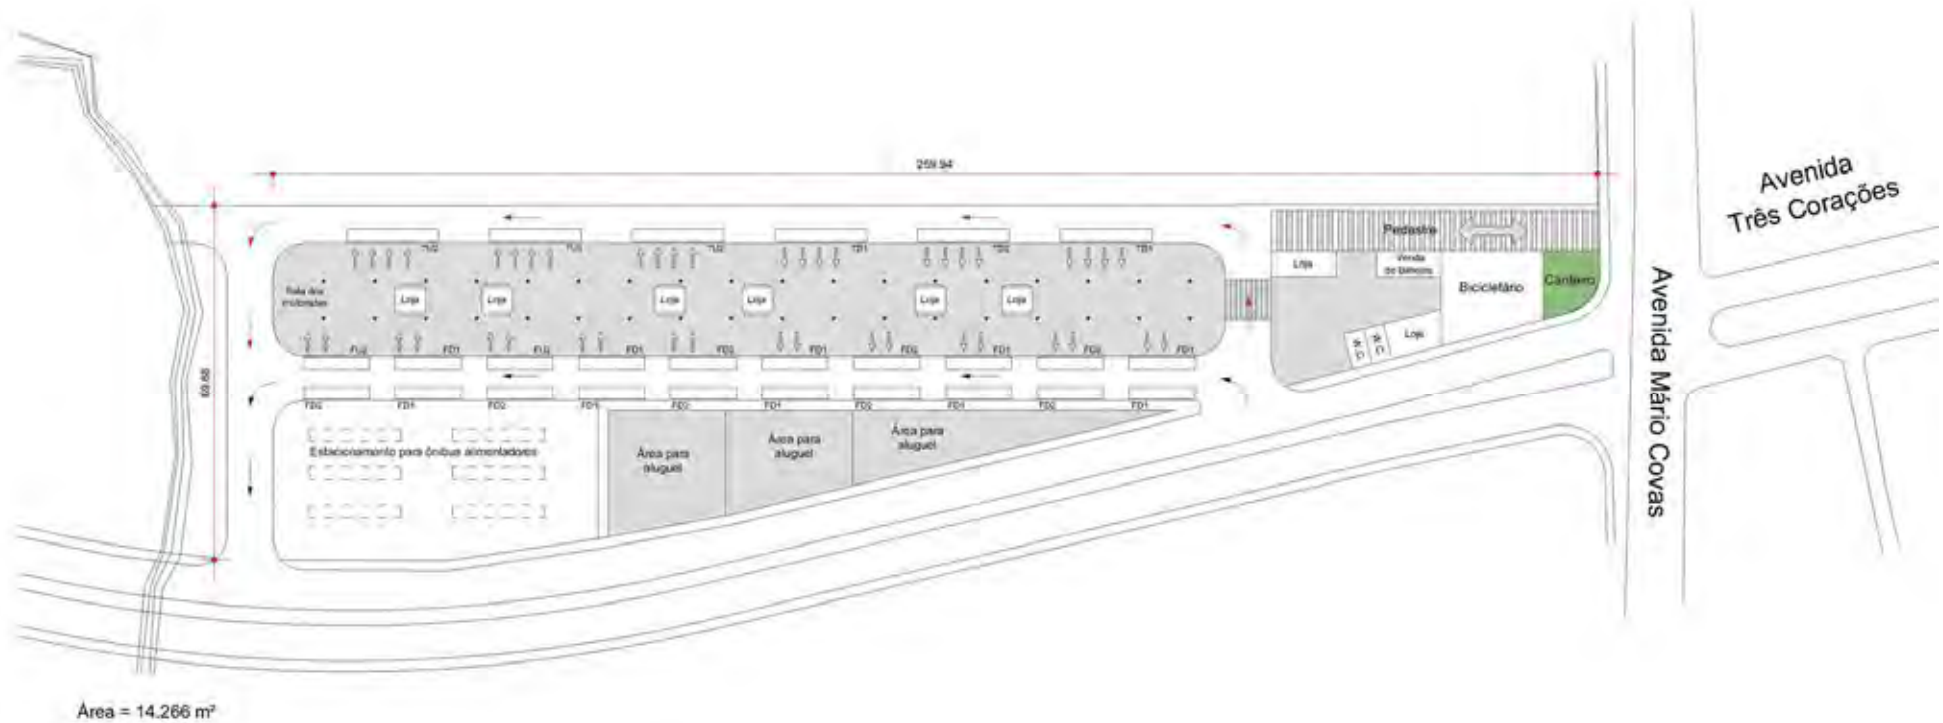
Planta baixa do Terminal Coqueiro (proposta)
